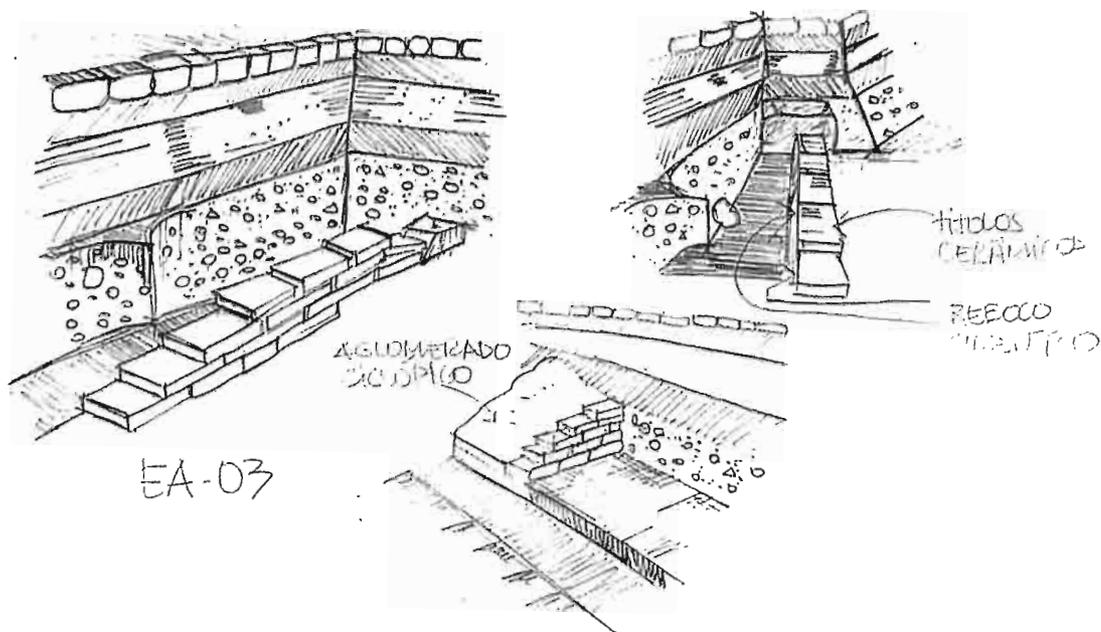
Vista da EA3 – disposição dos tijolos na estrutura. Fonte UFPE e Fundação Seridó.
